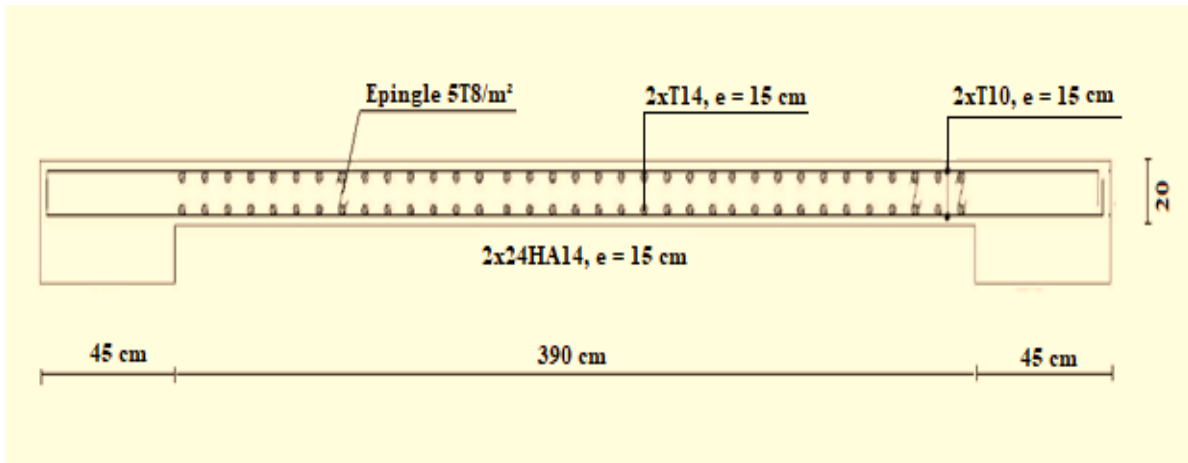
Schéma de ferrailage de voile V_T au niveau du RDC.
